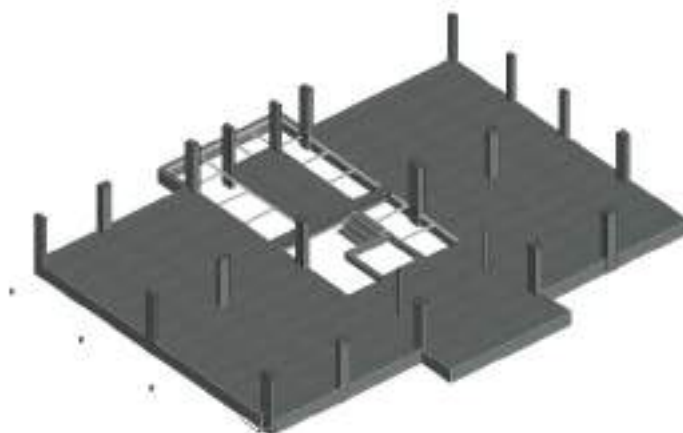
Perfis Suporte Painel Wall – 01 Pavimento
